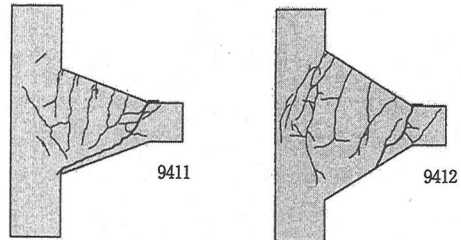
TYPE-IV①試験体 (ハッチが対称) のひび割れ発生状況
